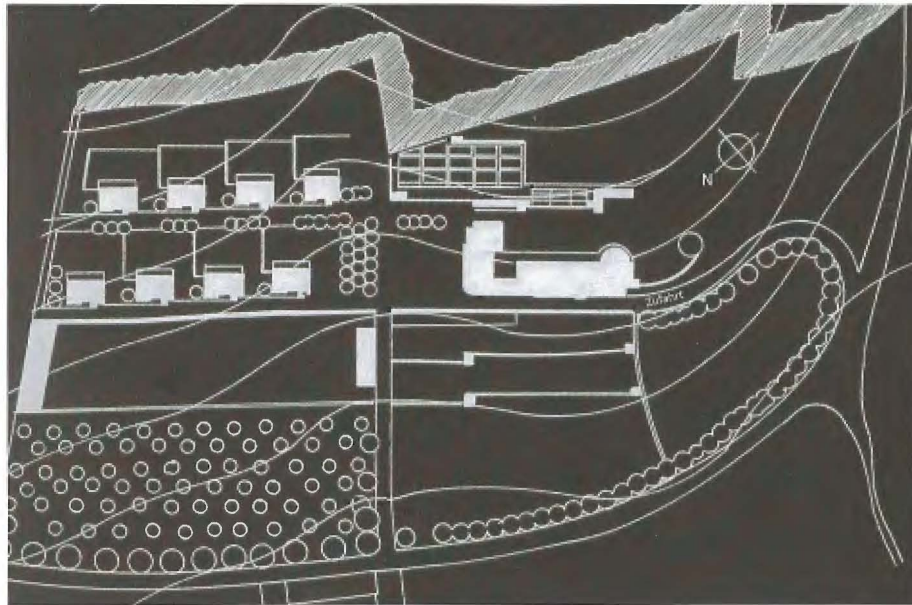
Lageplan der Gesamtanlage (Nachzeichnung des Originals)
